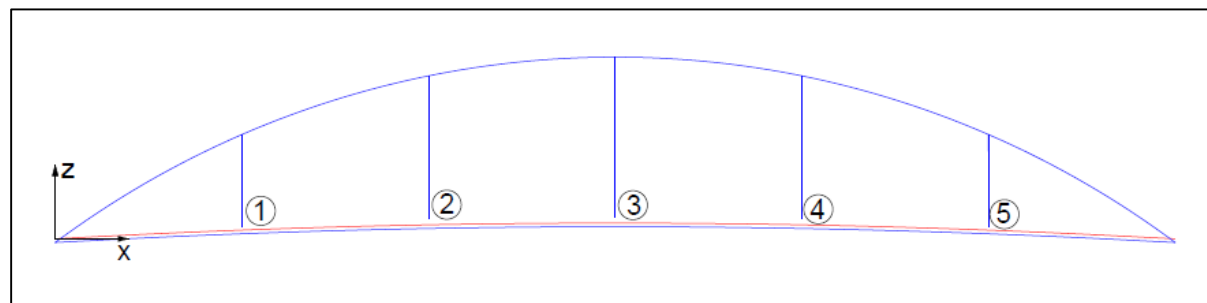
Numeración de los nudos de las péndolas rígidas en el encuentro con la viga longitudinal en SAP2000
